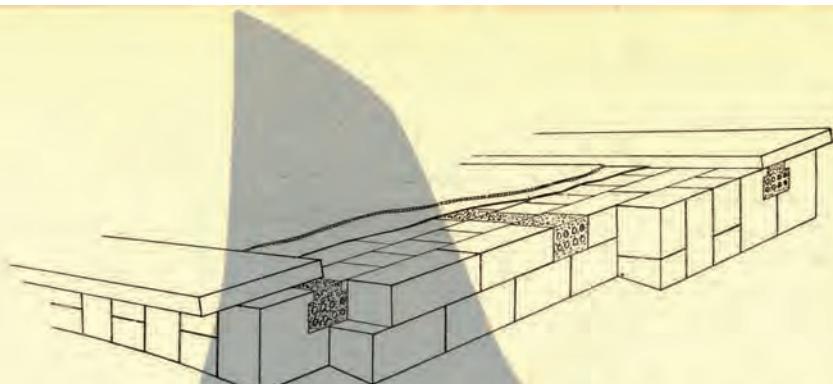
Perspectiva mostrando la situación de los paquetes de cables de pretensado.
